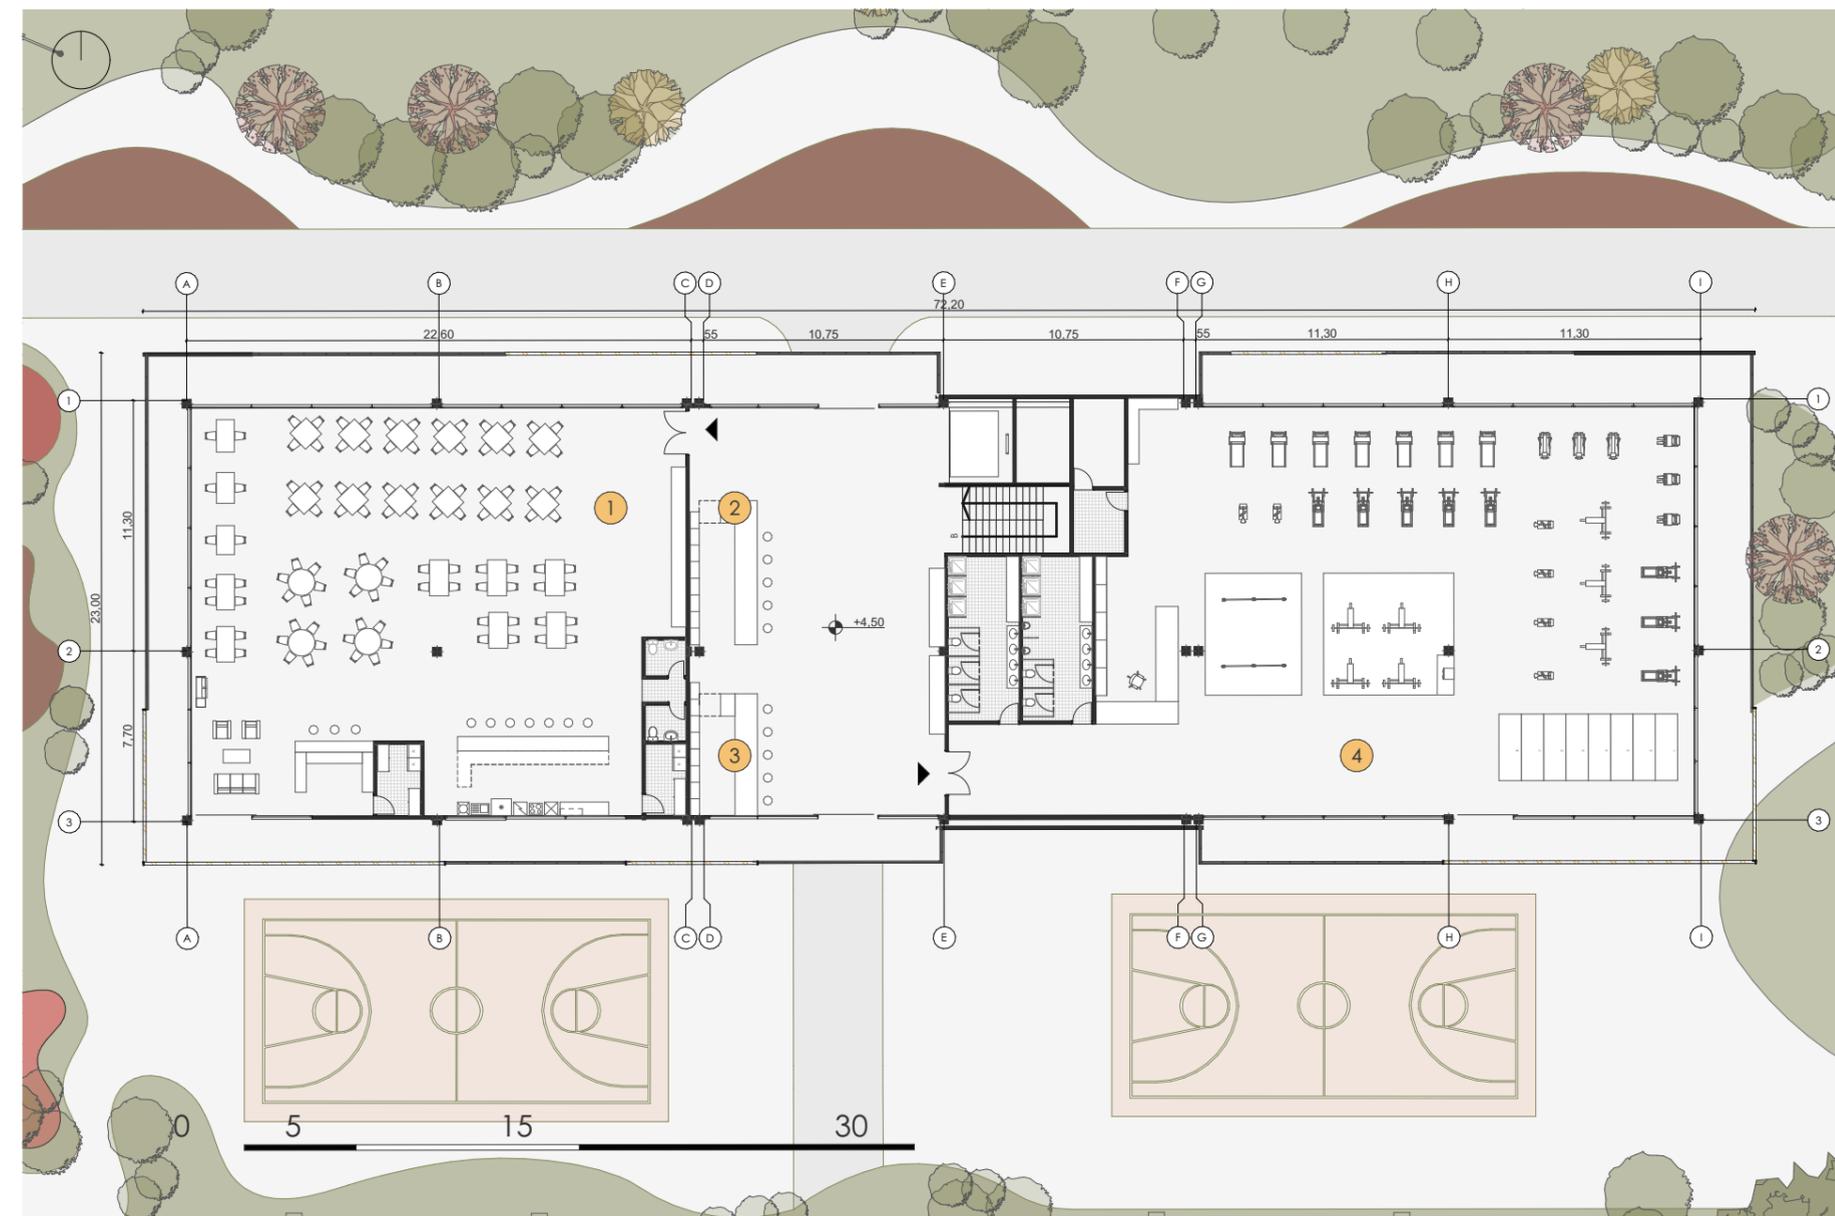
Planta alta bloque central Fuente: Propia, 2022
